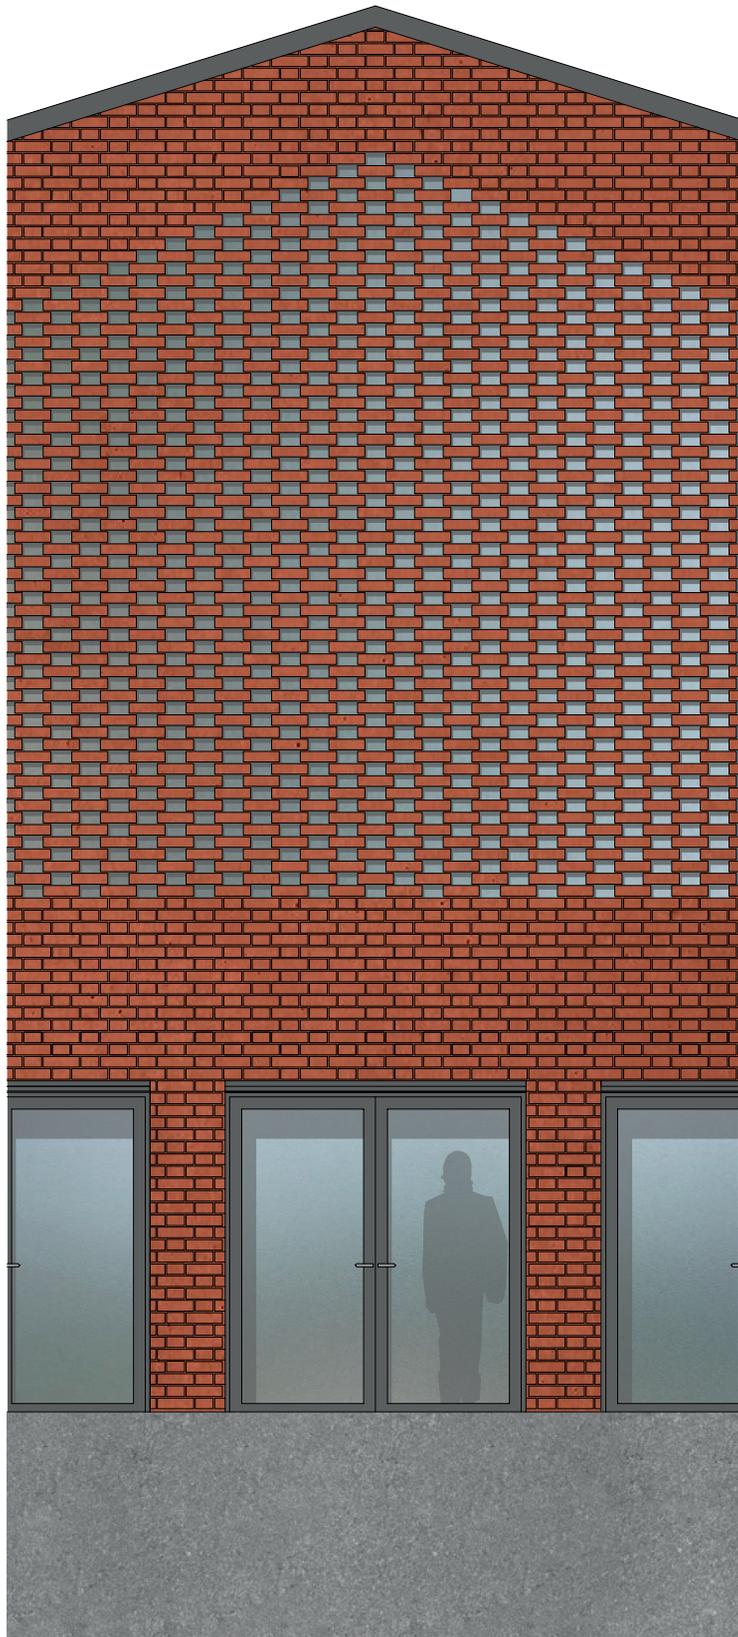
Fassadenschnitt und Ansicht Workshop-Halle
